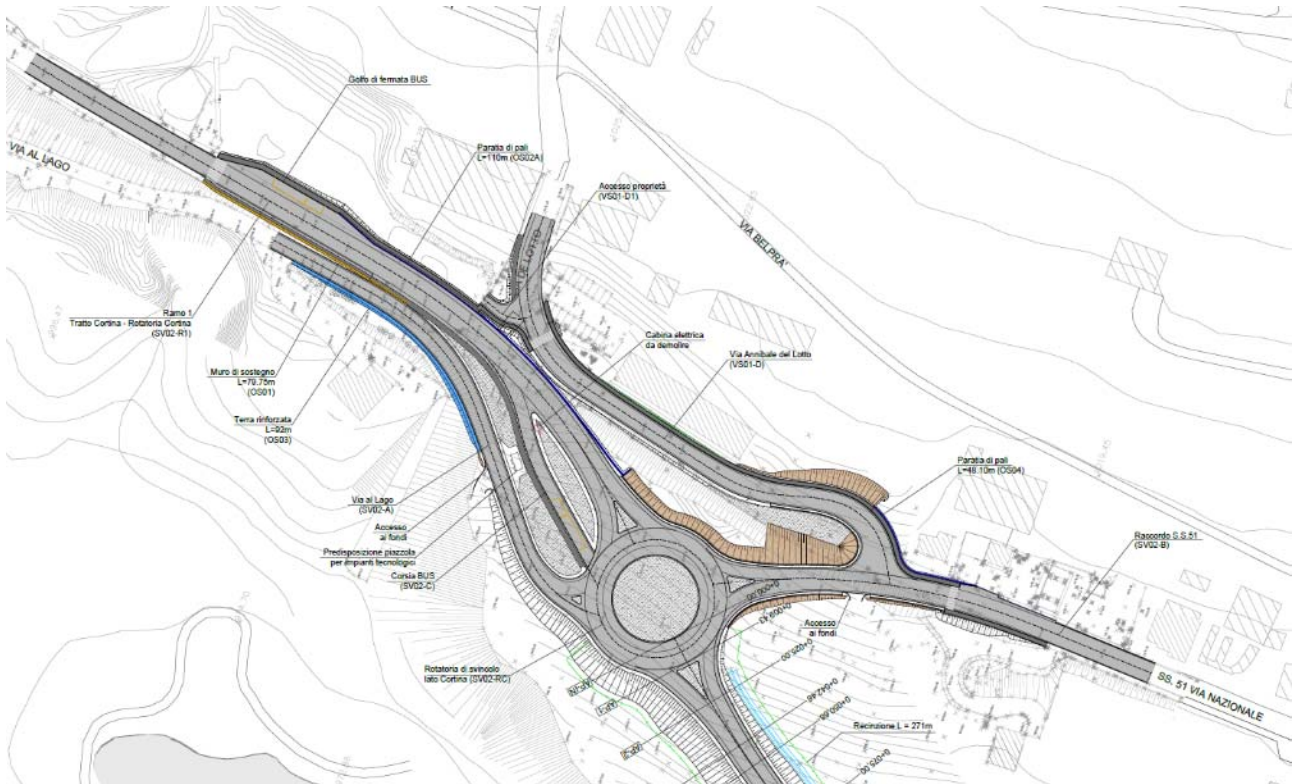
Stralcio planimetrico rotonda di Svincolo lato Cortina
